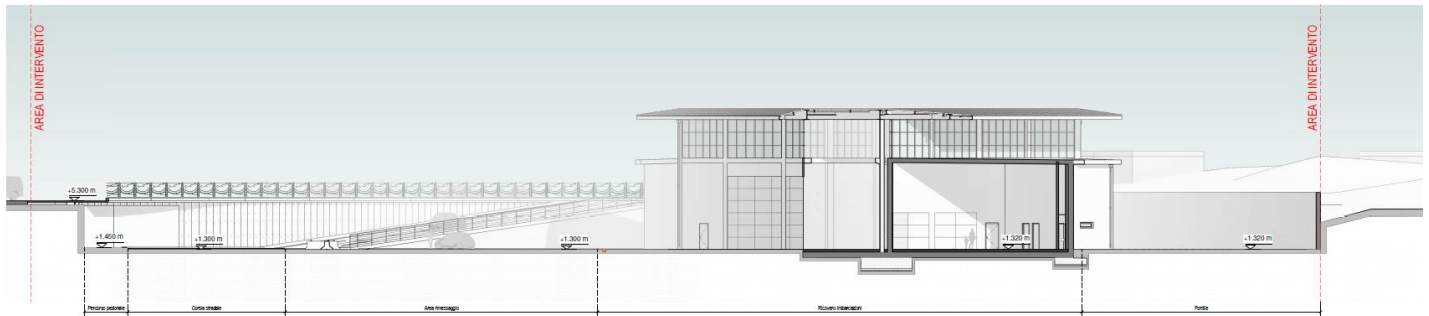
Sezione in corrispondenza del Ricovero imbarcazioni (estratto Elab.B17)
